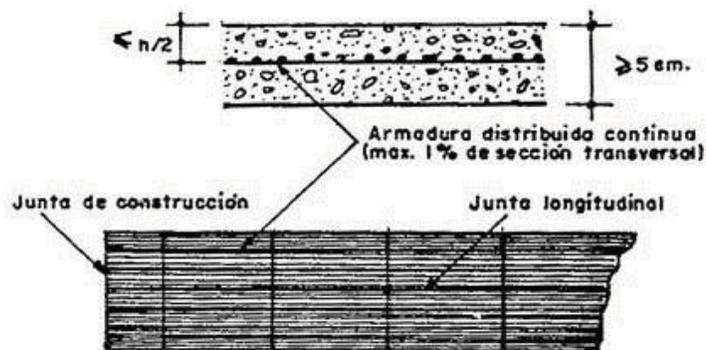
Estructura de un pavimento rígido con refuerzo continuo.
